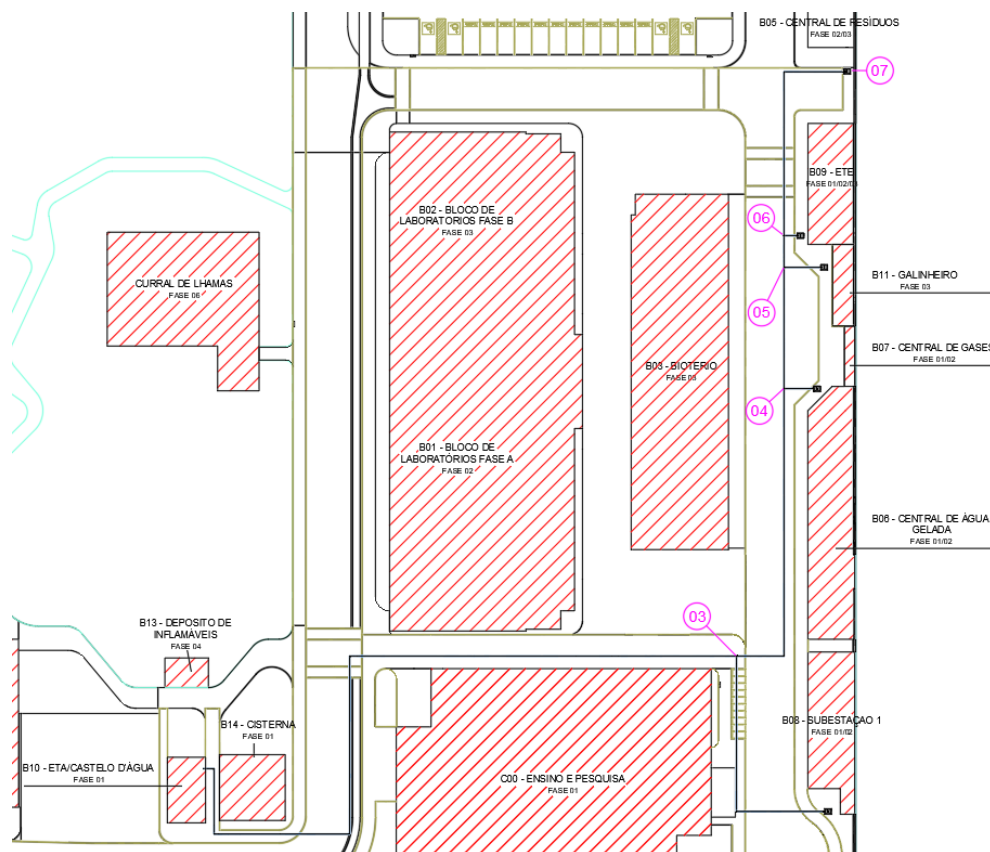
Planta trecho (Castelo d'água / Bloco B05)
